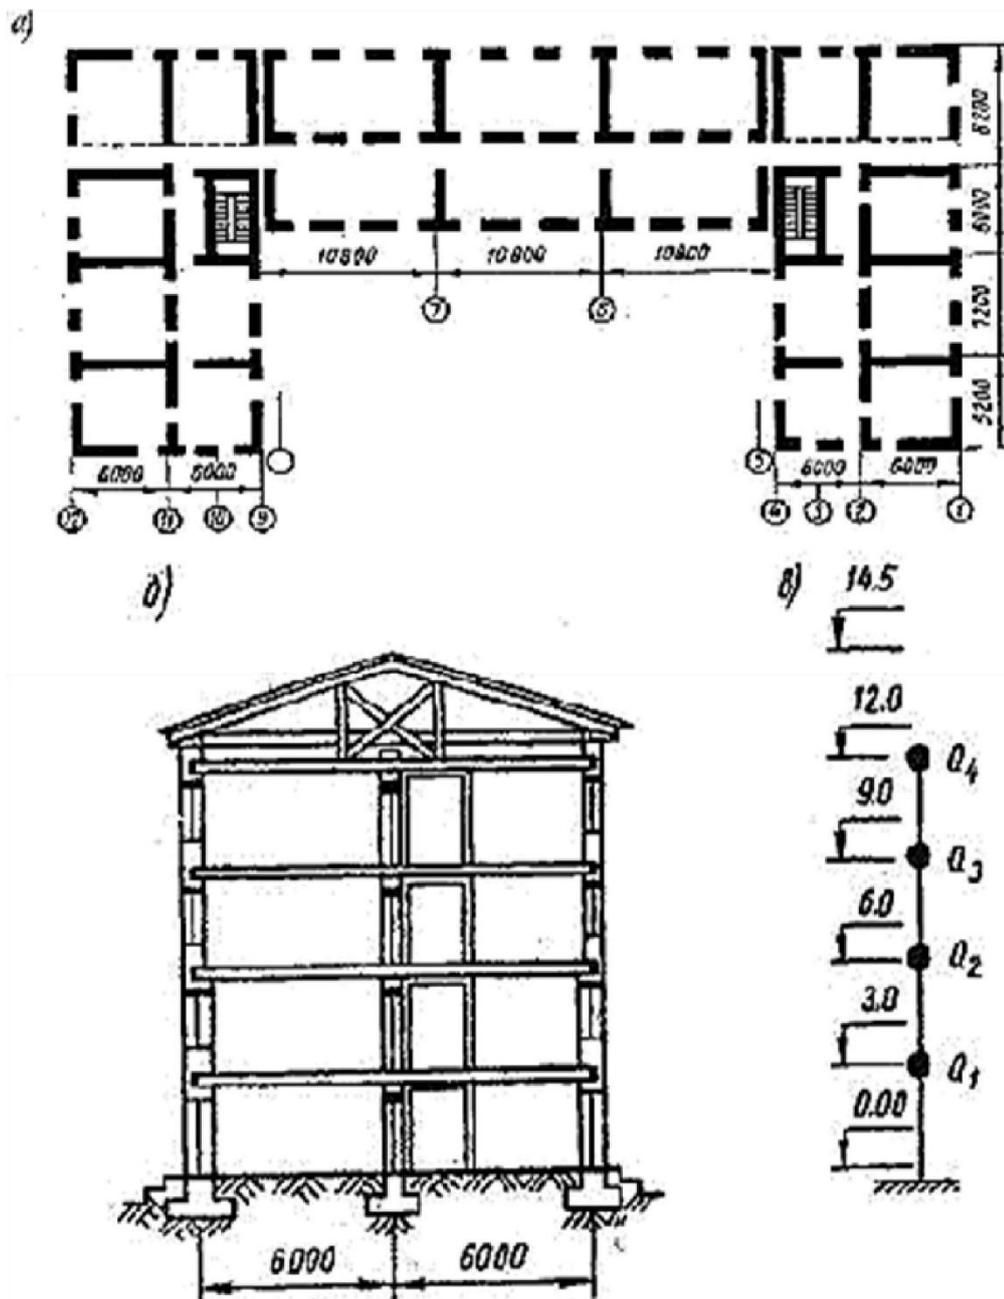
Кирпичный жилой дом: а – план типового этажа; б – поперечный разрез (перегородки условно не показаны); в – расчетная схема
